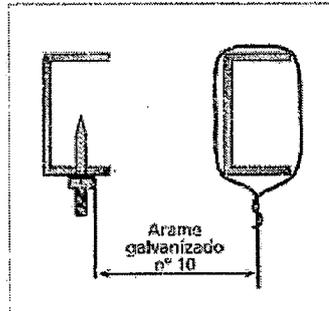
Fixação das tirantes na estrutura metálica do telhado
